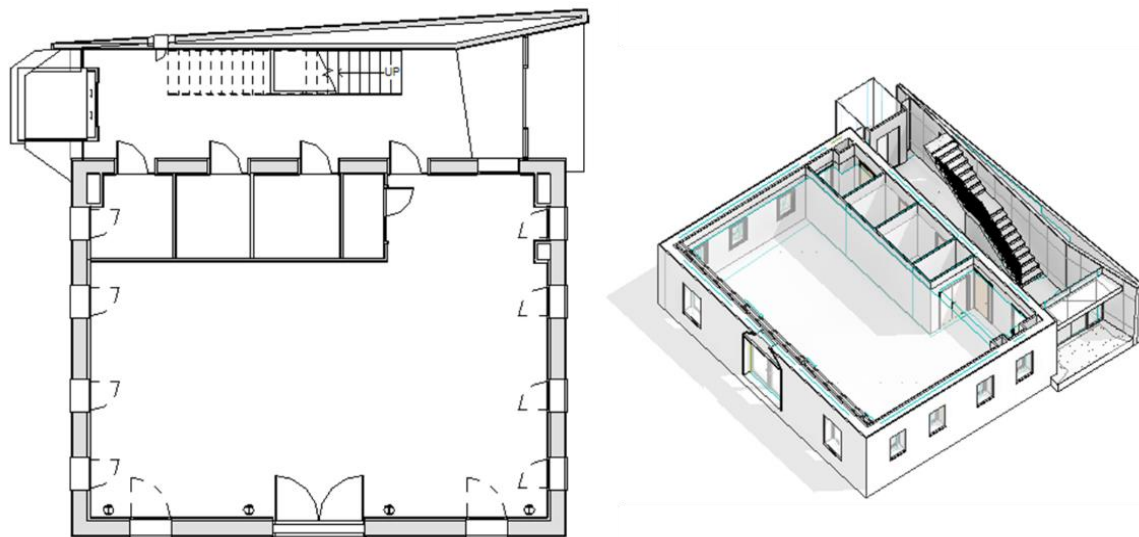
Planta baja - Edificio de la sede UOC en el Baix Llobregat
